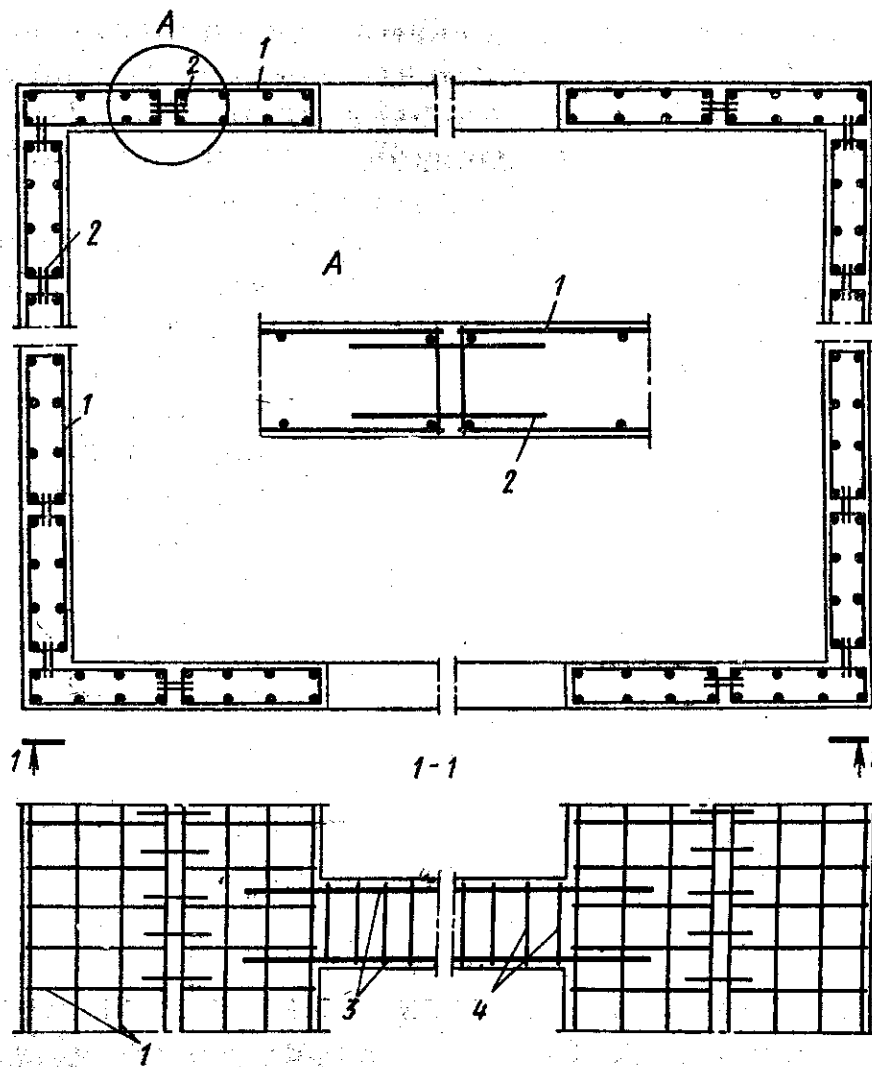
Схема конструирования арматуры монолитного ядра жесткости
